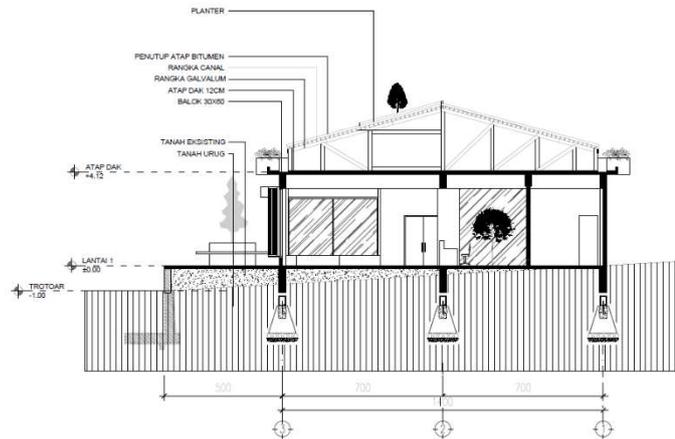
Sistem Struktur Grid pada Bangunan
